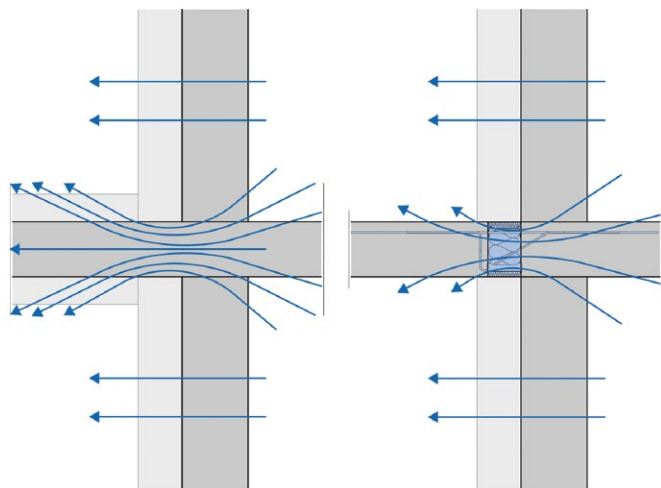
Wärmebrücke und Wärmeverlust links ohne, rechts mit Schöck Isokorb®
